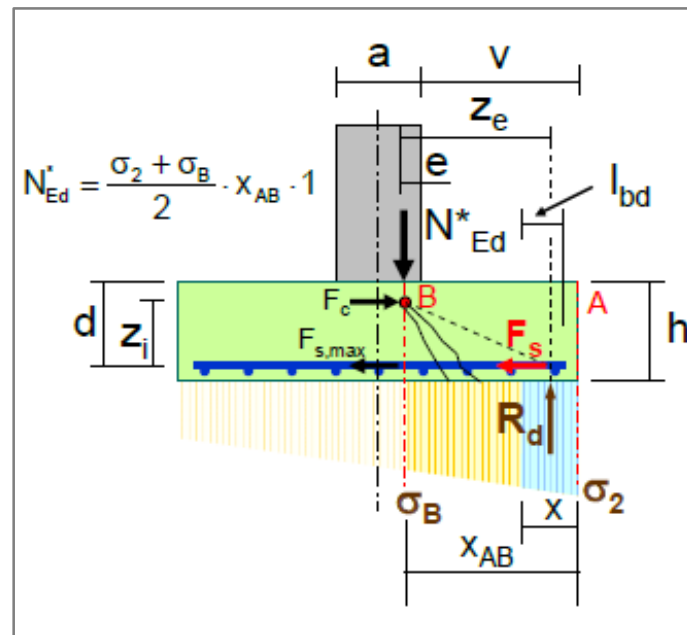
Croquis para cálculo de longitud de anclaje en cimentación. Referencia: Apuntes "Hormigón I" Unidad Docente Hormigón (UPV).
